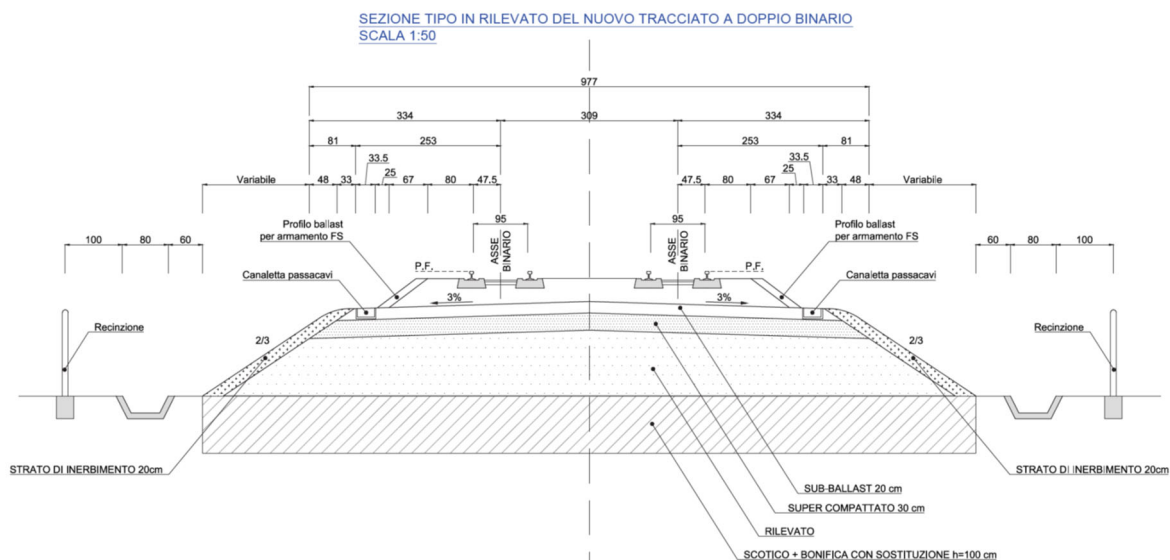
Progetto di Raddoppio – Sezione tipo del tracciato in rilevato – Palo del Colle-Toritto.
